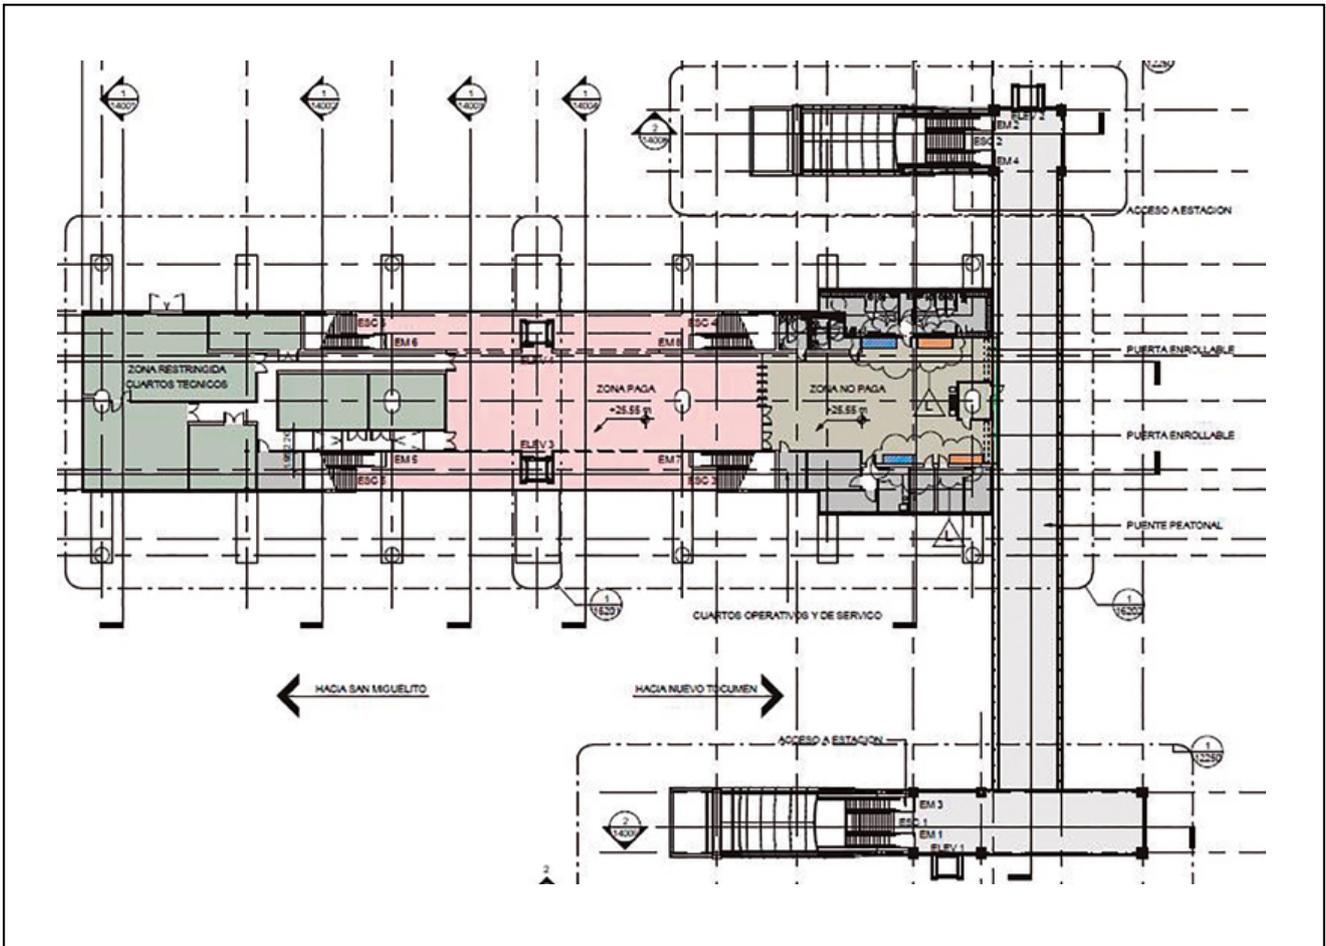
Estación Corredor Sur – Vista en planta del nivel vestíbulo.
